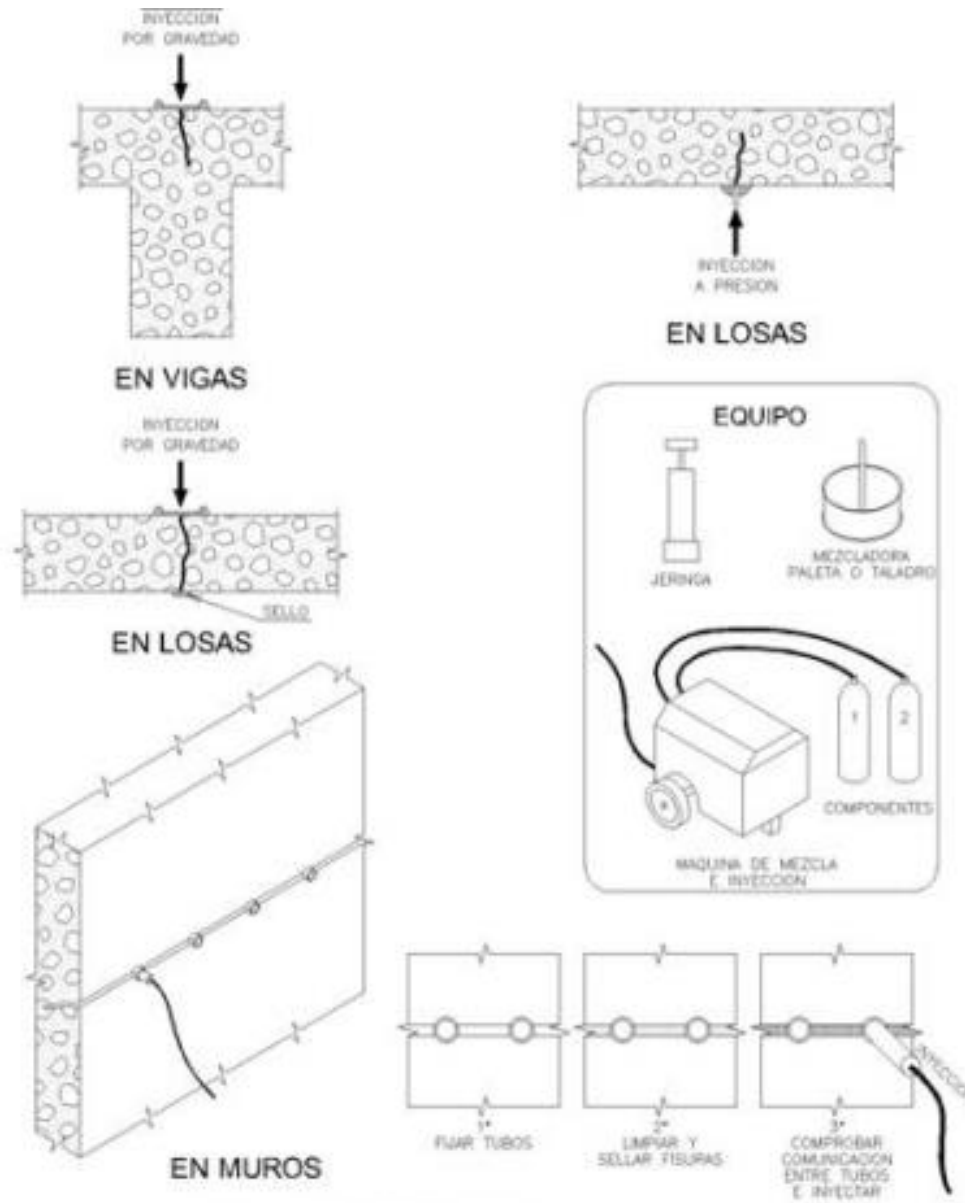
Esquemas de inyección de grietas y fisuras 1
